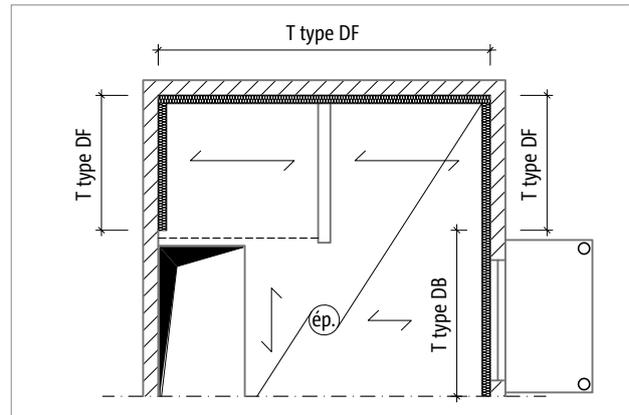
Schöck Rutherma® T type DF : utilisation entre la dalle et la façade
